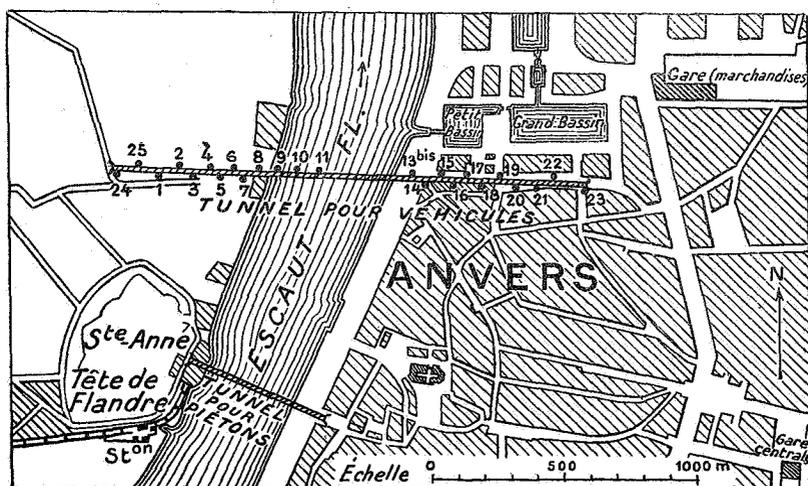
Plan de l'emplacement des tunnels sous l'Escaut.
